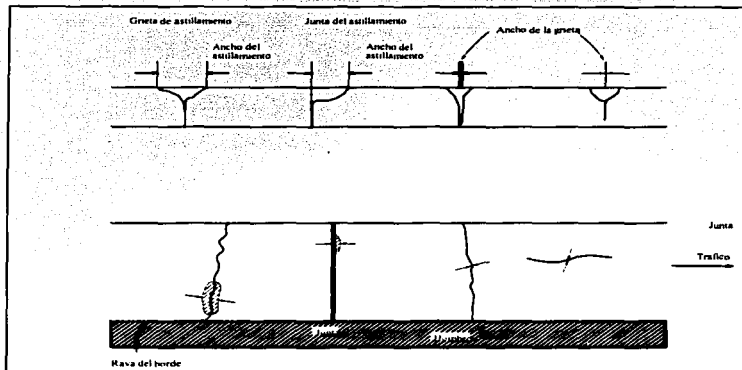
Anchos de astillamientos y grietas en la junta de pavimentos de concreto.
